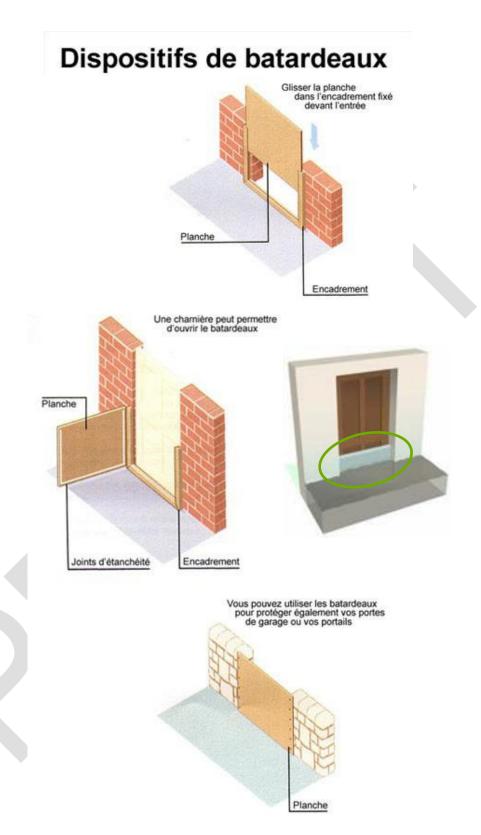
Exemples de batardeau à mettre en place en cas de crue
